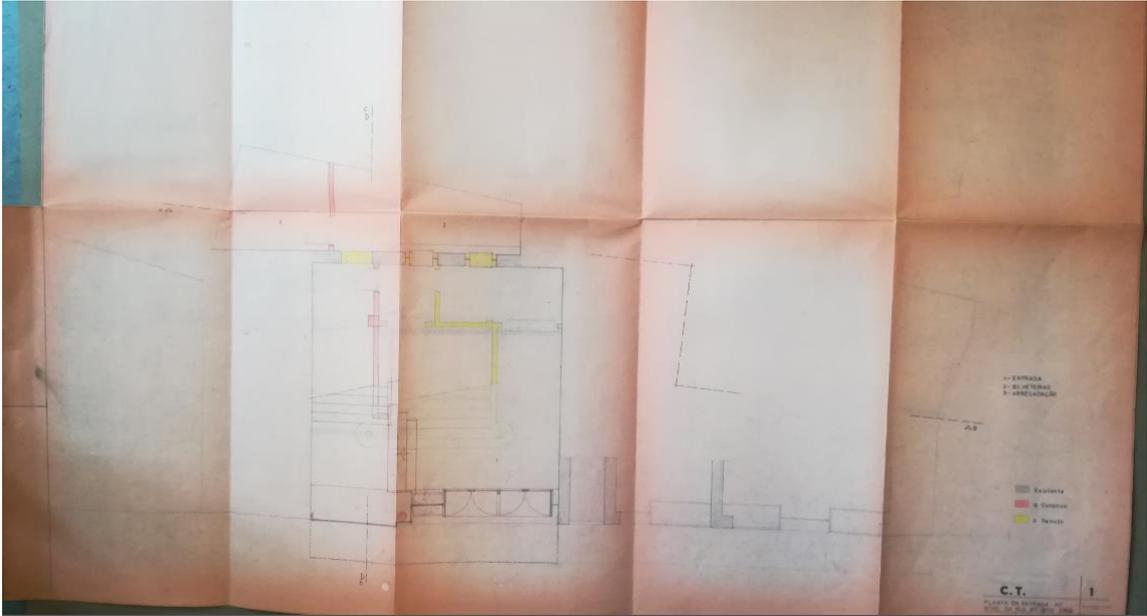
Planta ao nível da entrada para a Rua Dr. Ricardo Jorge
